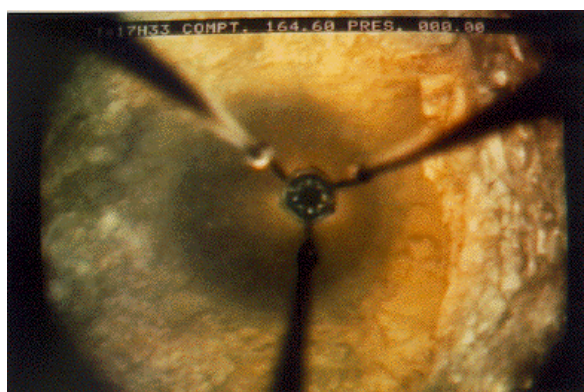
(164.6 m)-Zona fracturada, sección irregular y deformada.
